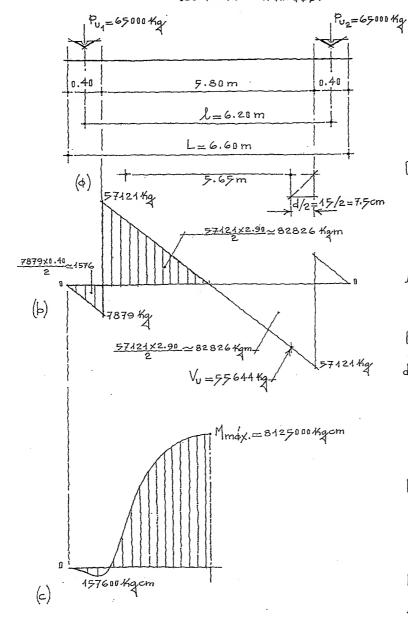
Detalle de la lougitud de desarrollo yanclaje, (c).
